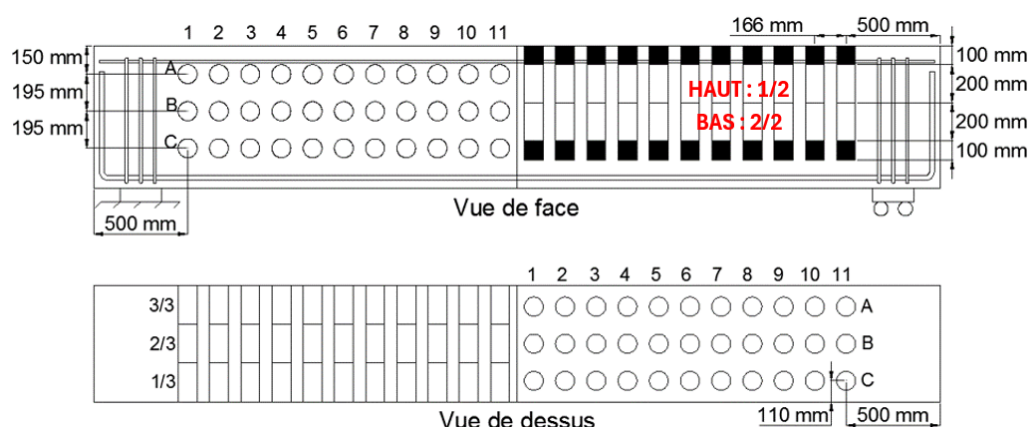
Plan de carottage dans les dalles en béton armé - Allard et al., 2016
